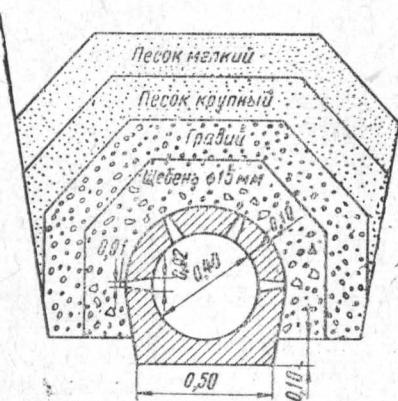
Бетонная труба и схема дренажа для сбора подземных вод.
